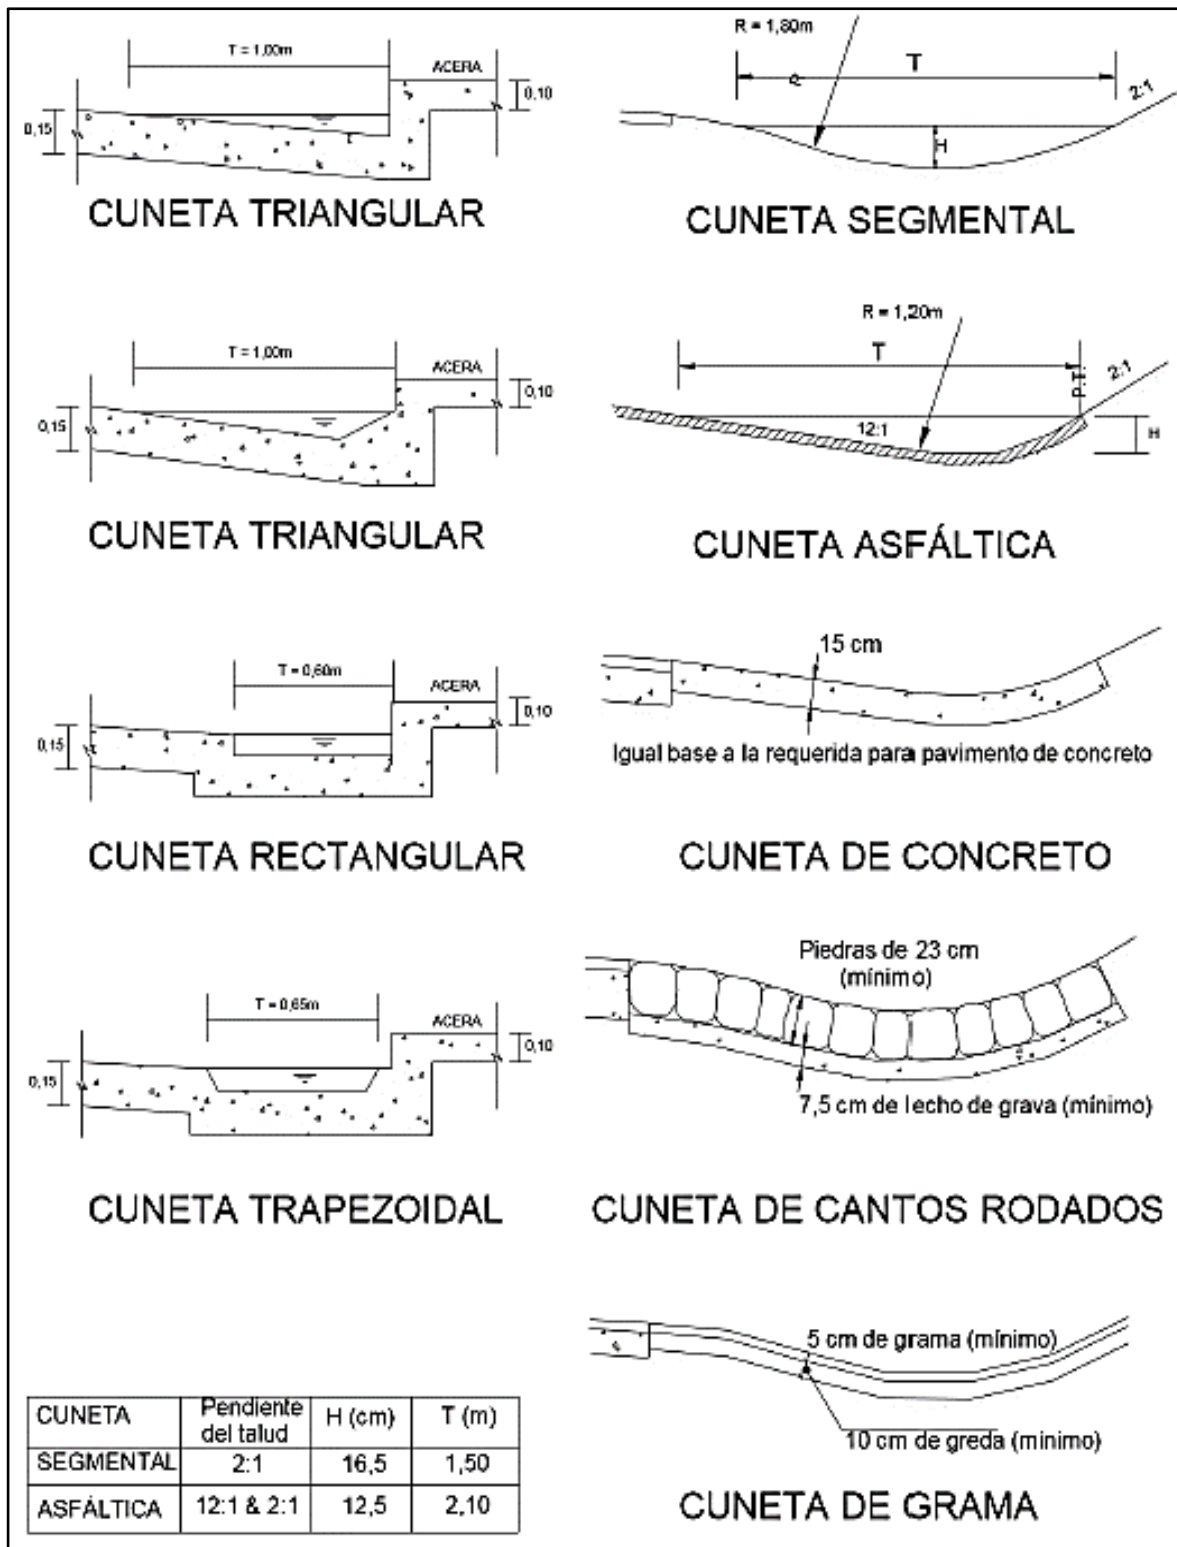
Sección Transversal de Cunetas. Fuente: Norma OS.060 - Drenaje Pluvial Urbano.
